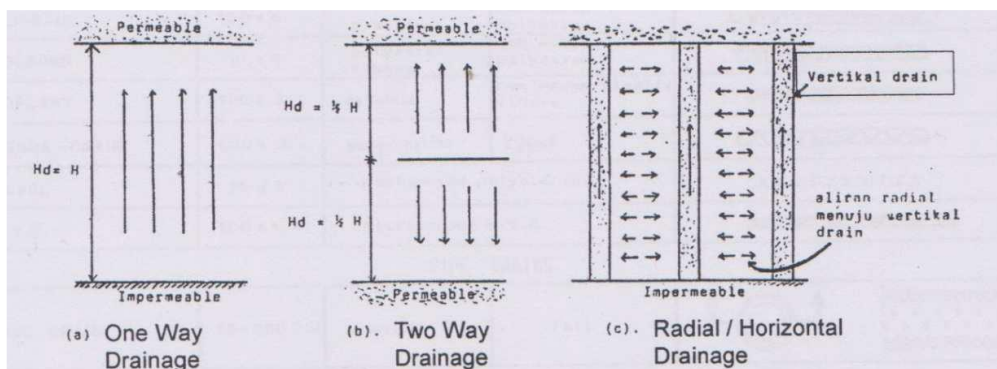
Sistem preloading dengan Prefabricated Vertical Drain
